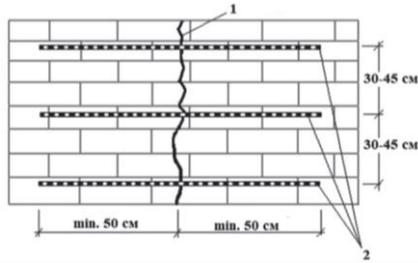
Армирование кладки отдельными стержнями по технологии Britt Technologies: 1 – трещина; 2 – армирующие стержни Britt Saver Powder
